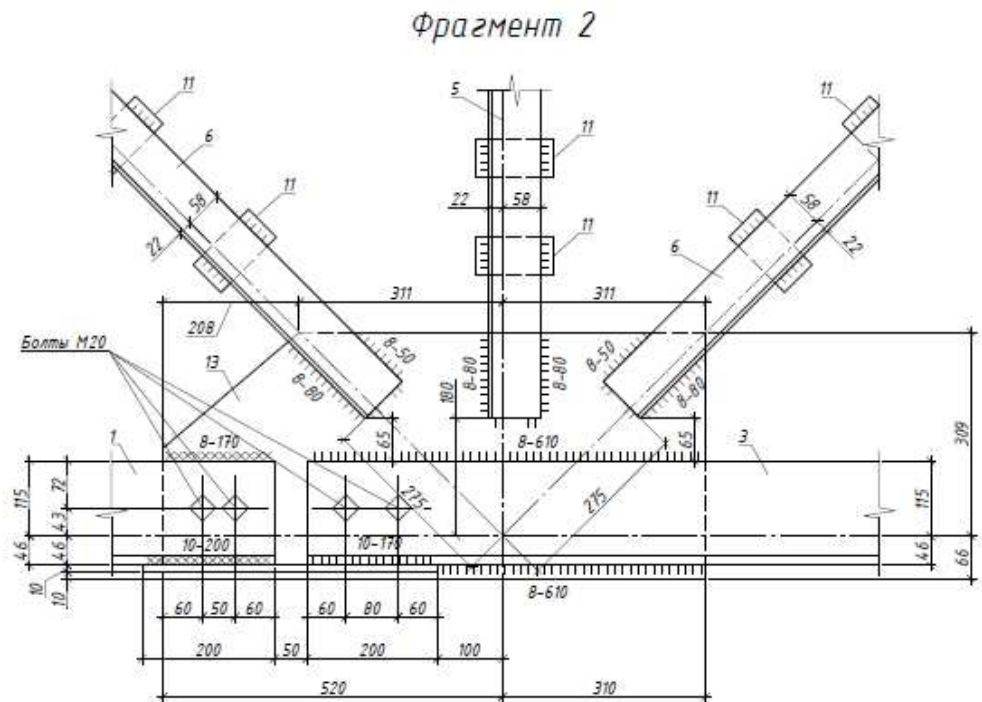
Узел сопряжения нижнего пояса фермы
